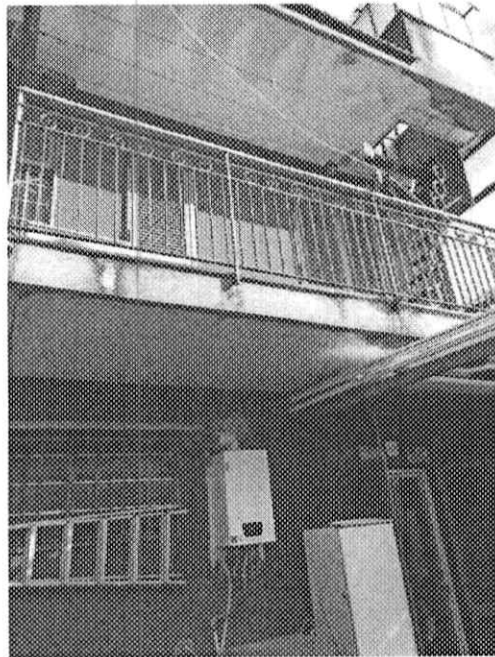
• Terrazzo avente accesso dalla cucina (di fronte si vedono il piccolo ripostiglio esterno e la zona attrezzata con cucina in muratura).
